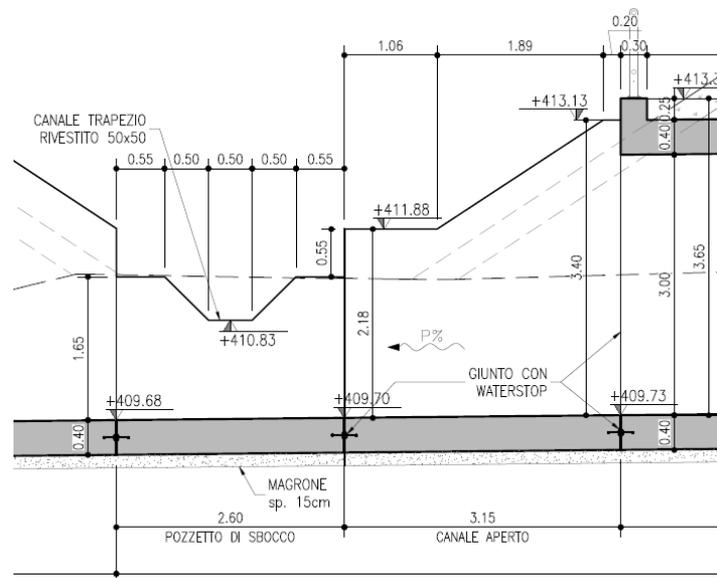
Manufatto di sbocco - Sezione longitudinale
